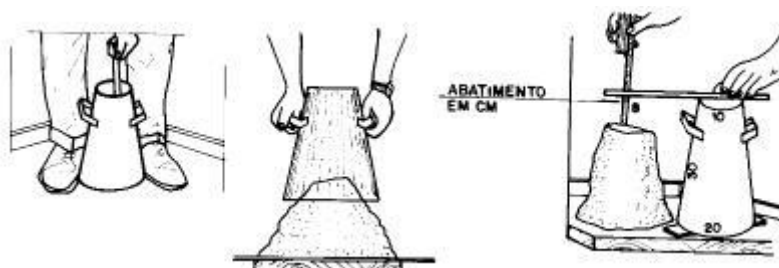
Essai d'affaissement au cône d'Abrams.
